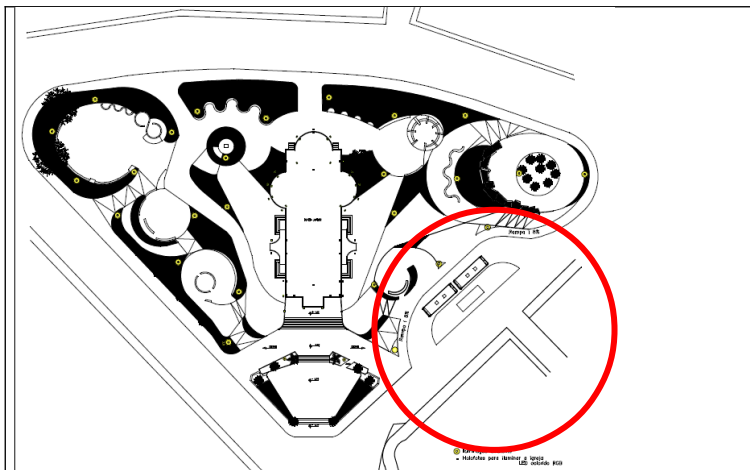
Vista da Praça com a intervenção proposta em destaque.
